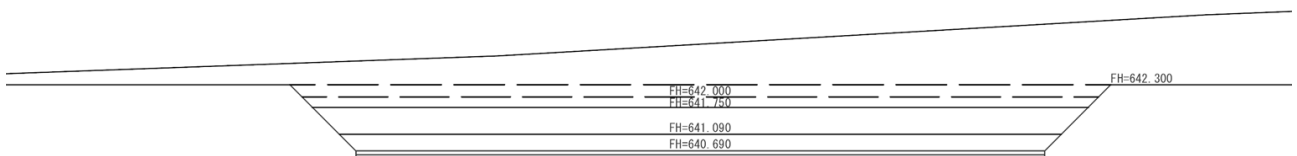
(2) 沈砂池断面図 (2号機例)
